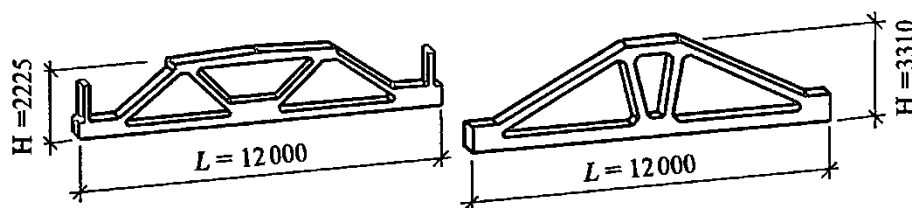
Номенклатура основных типовых конструкций железобетонных ферм производственных зданий: а) стропильные фермы; б) подстропильные фермы
